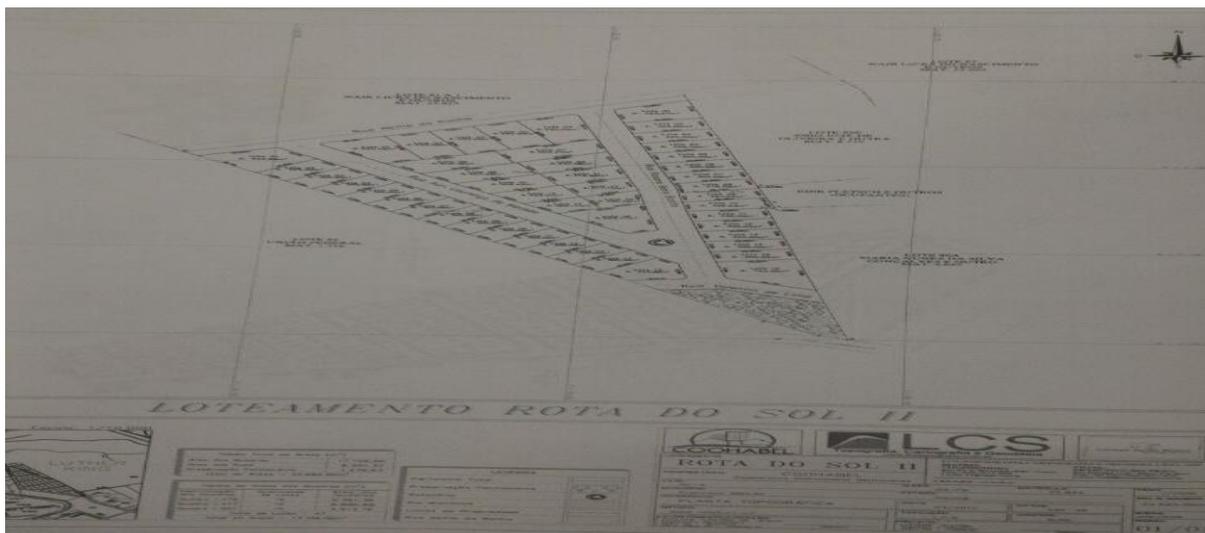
Croqui da planta do Loteamento Rota do Sol II
